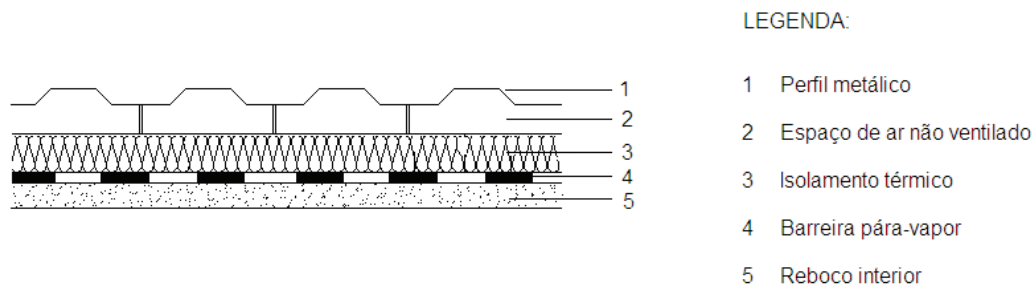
Pormenor construtivo da cobertura metálica, com barreira pára-vapor.
